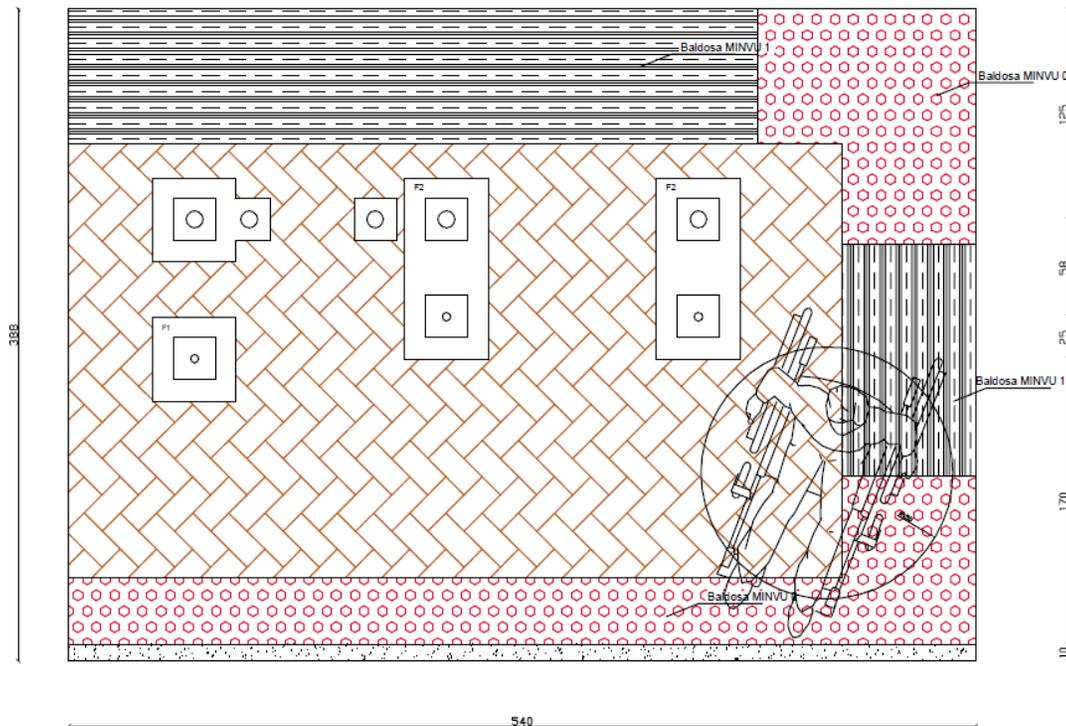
Dimensiones Diseño del paradero Simple, Planta
